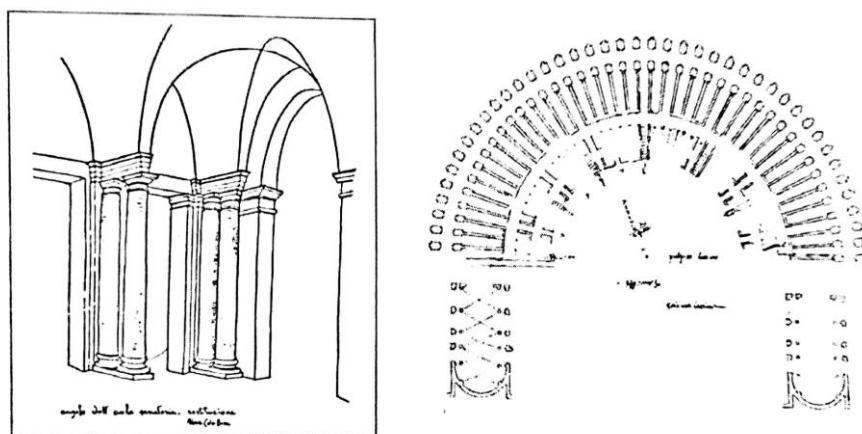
Ricostruzione del colonnato delle basiliche e planimetria di A. da Sangallo (XVI sec.)
